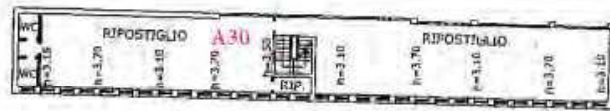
Ostiglia - Capannone A - Planimetria con indicazione locali
